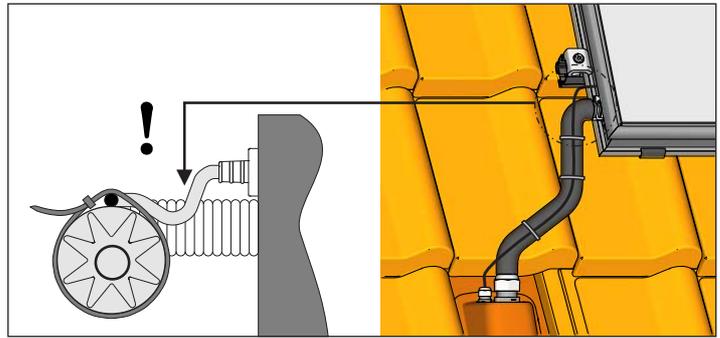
Fase di lavoro 3 (raffigurata sul sistema Drain-Back  $p=0$ )
